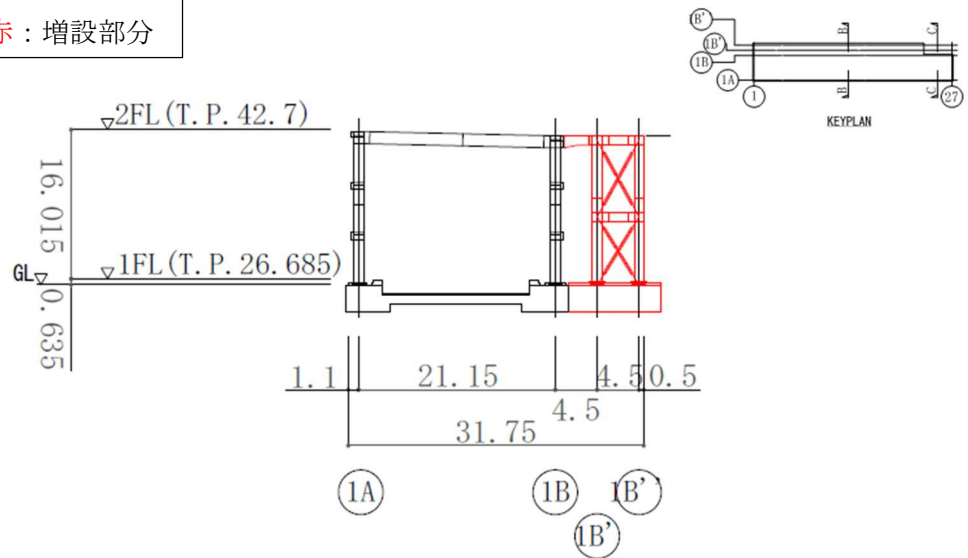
(6) B-B 断面图 (NS 方向) (单位：m)
